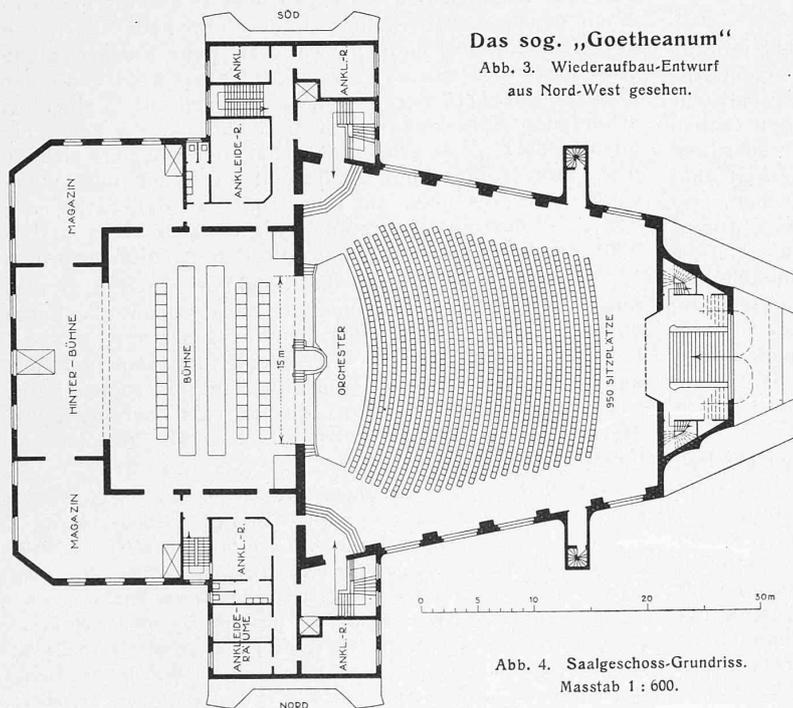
Saalgeschoss-Grundriss. Masstab 1:600.
